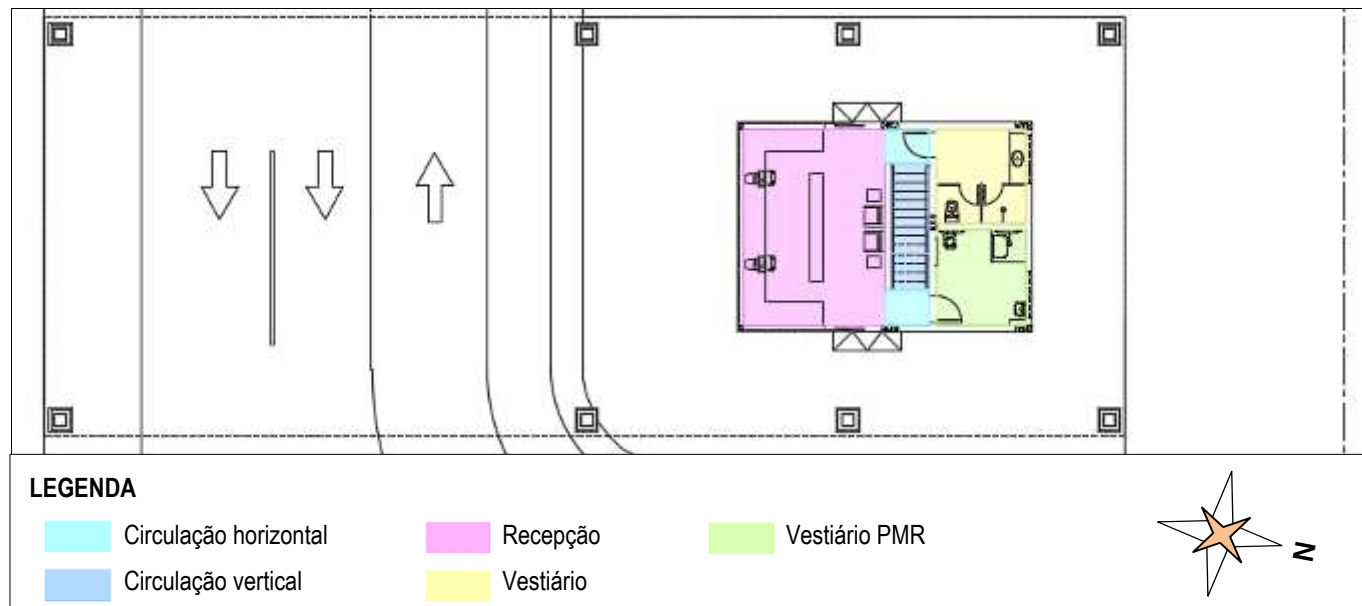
Planta setorizada do pavimento térreo do bloco 01.
